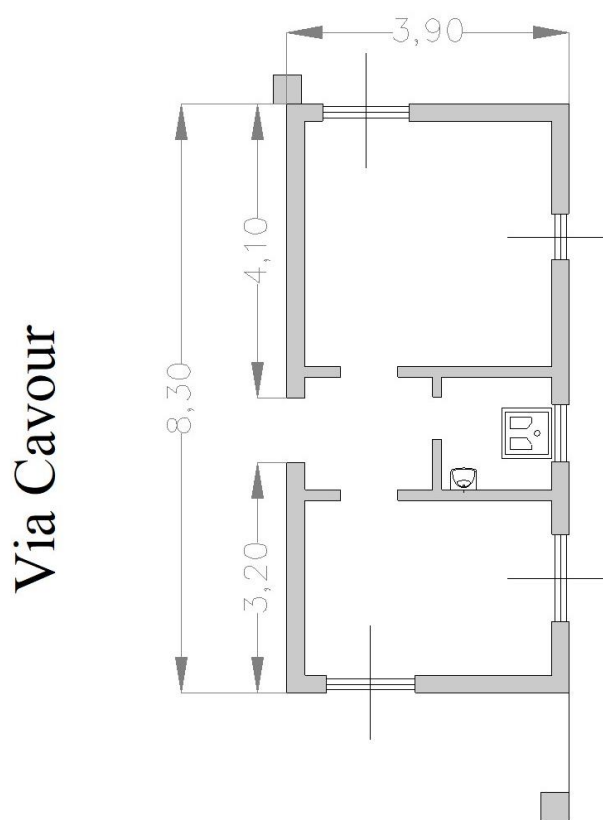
Planimetria del piccolo manufatto adibito ad ufficio
